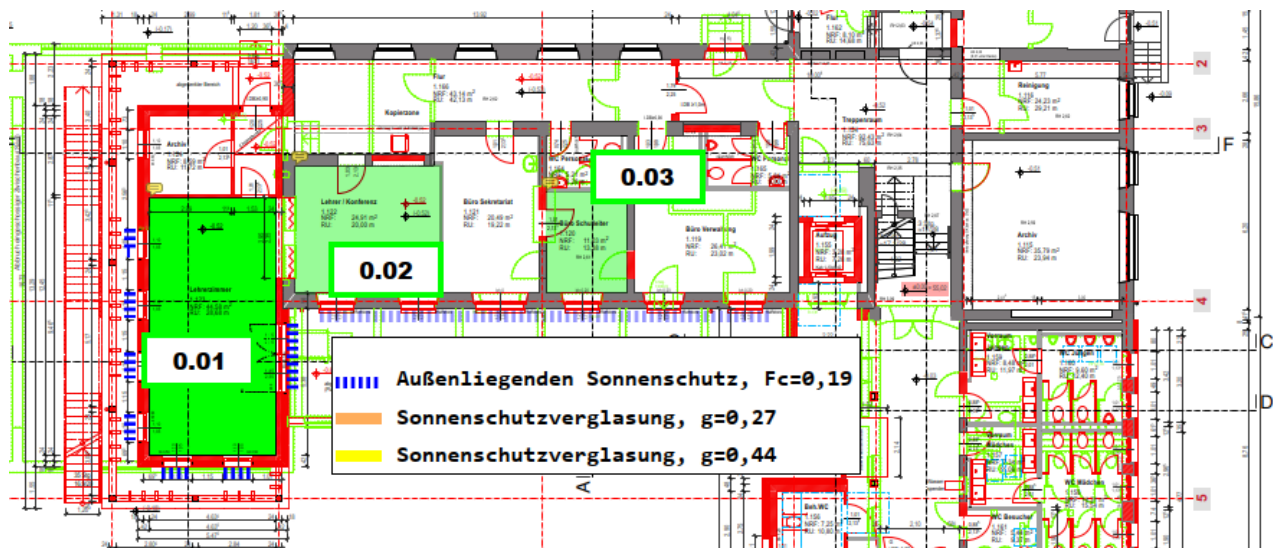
Erdgeschoss – geprüfte Räume (grün markiert).
